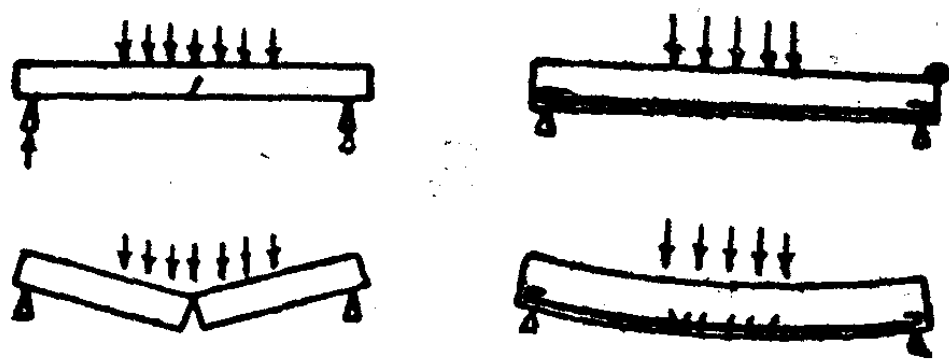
純混凝土与鋼筋混凝土梁工作示意
